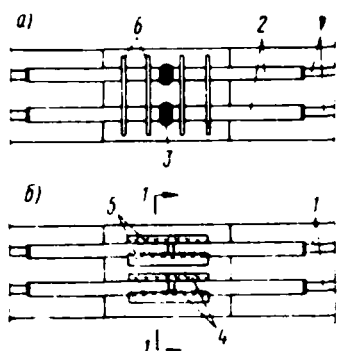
Стык нижнего пояса ферм со сваркой стержней
